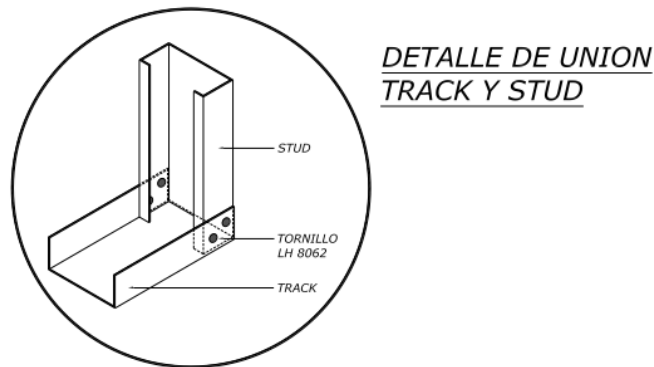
Detalle de unión de perfiles para gypsum en pared.
